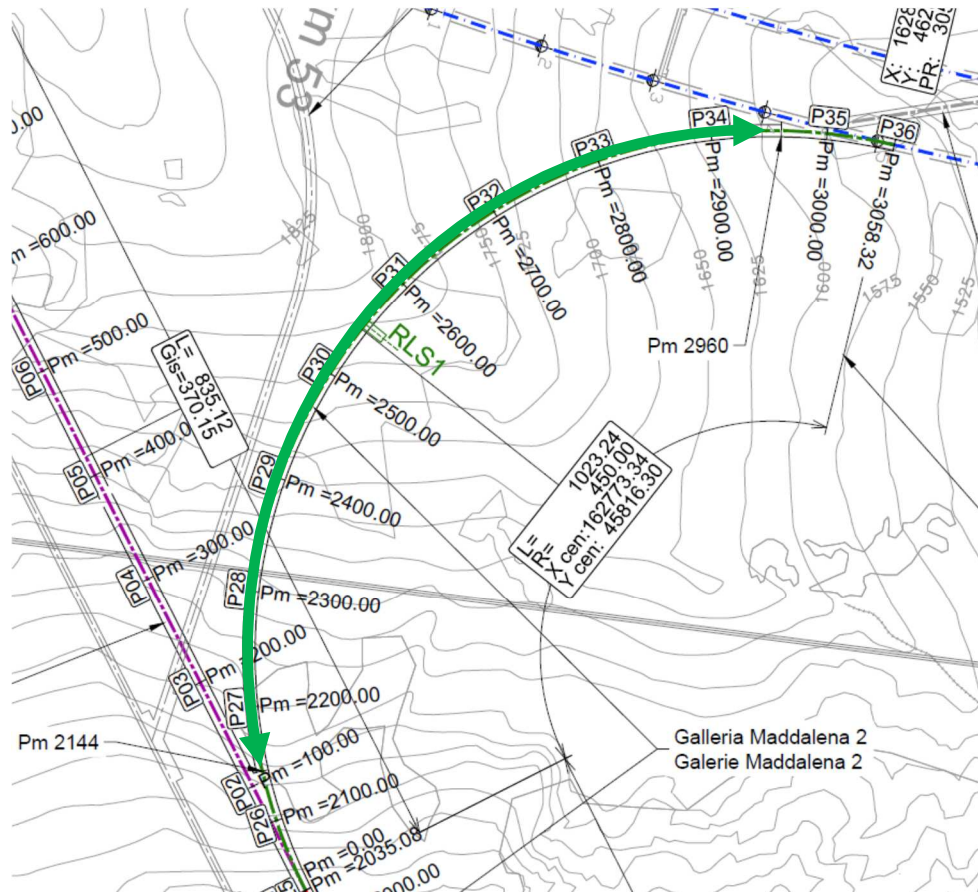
Planimetria delle zone di stoccaggio in Maddalena 2 (PRV_C3A_7520_26-48-11)
